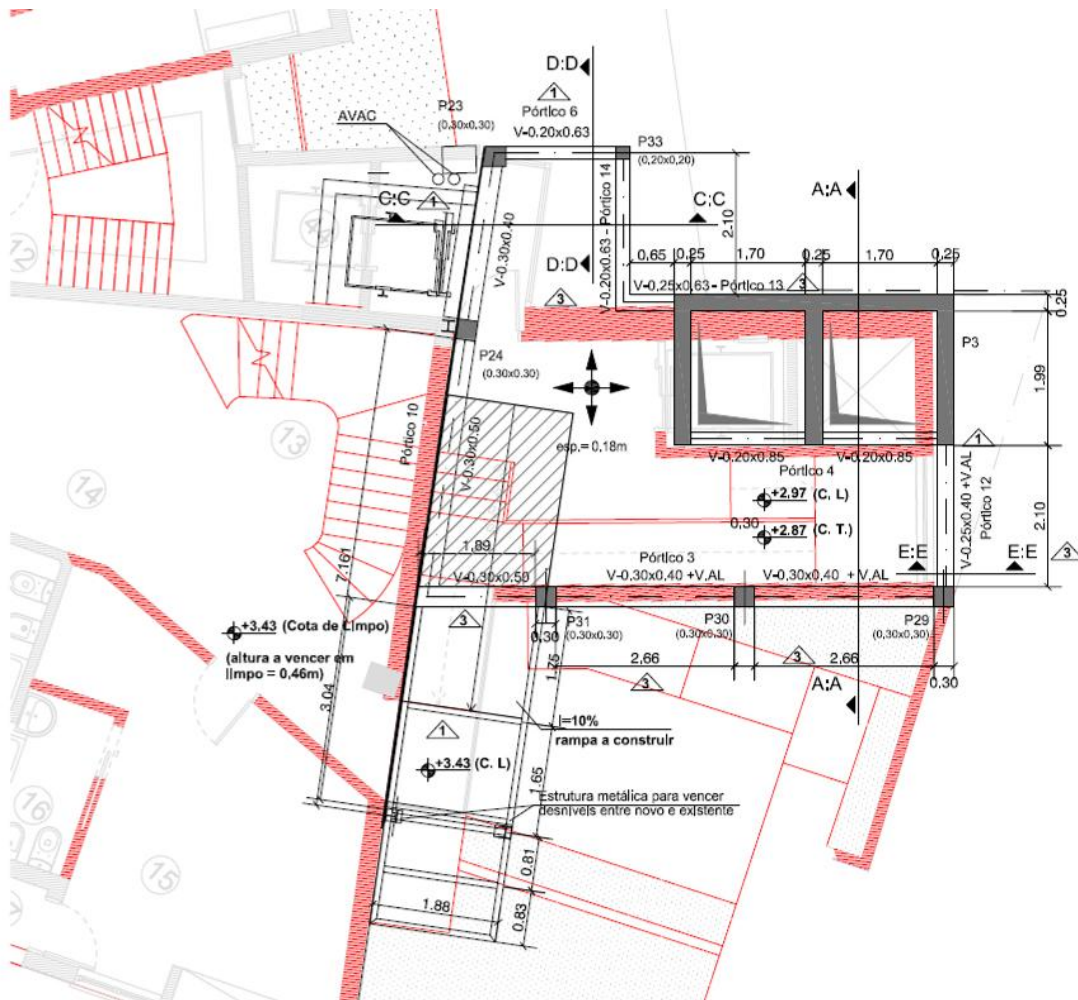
Planta do piso 1 - preparação dos trabalhos [AVicêncio A, 2017]
